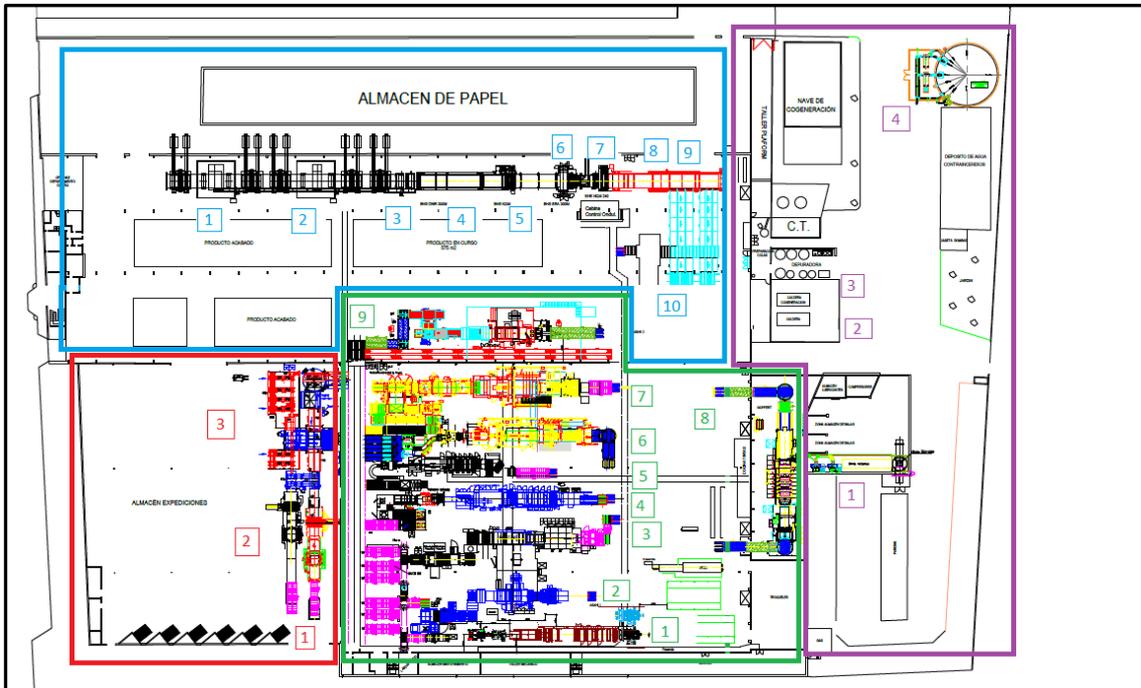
Zonas de maquinaria en la planta Smurfit Kappa Quart
